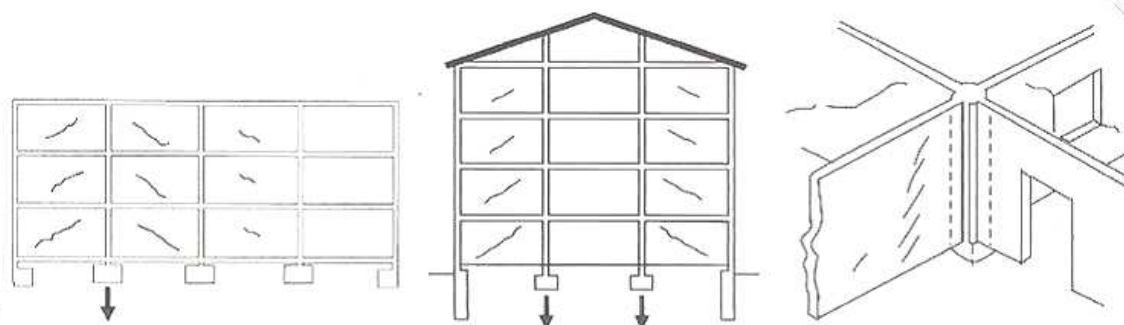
Fissuras típicas causadas por recalque de fundações de pilares internos - CONSOLI; MILITITSKY; SCHINAID, 2008.
